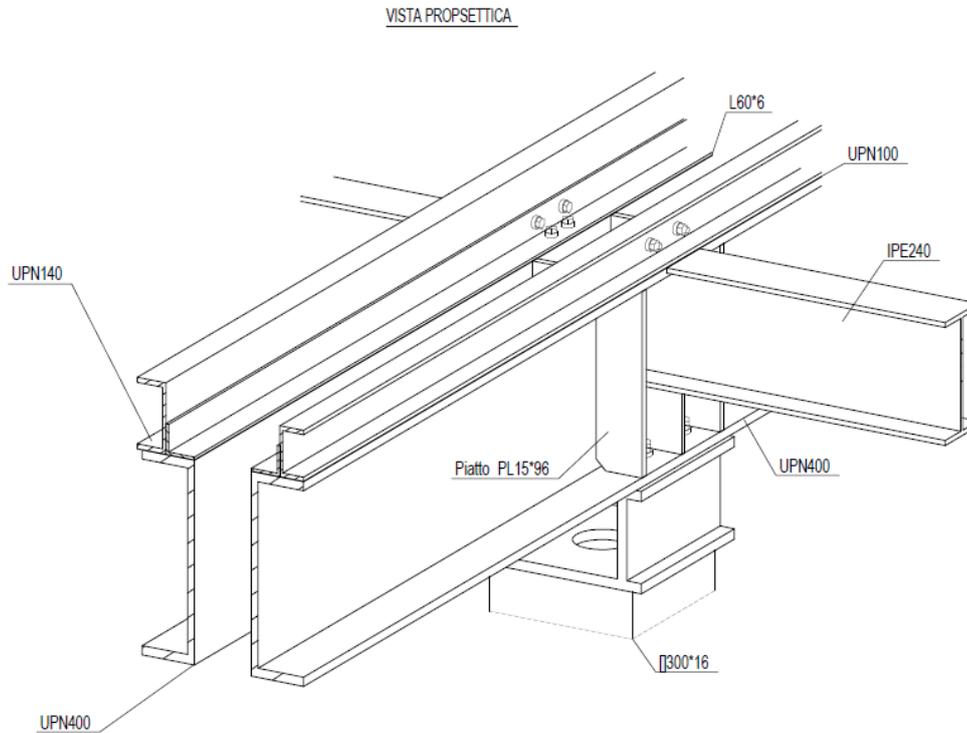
Pensiline – Vista prospettica nodo di collegamento trave-colonna
